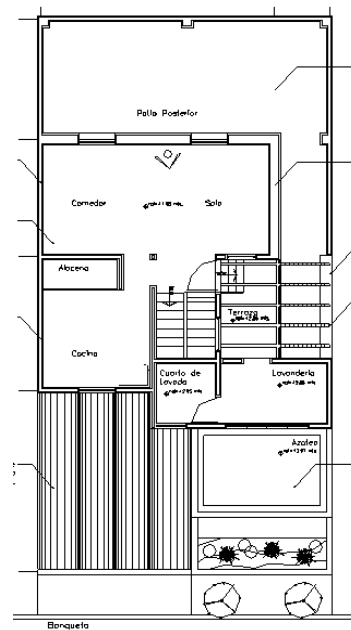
Planta nivel +1.62 En ésta se ubica el área de recepción, cocina, además de en un nivel +2.64.
